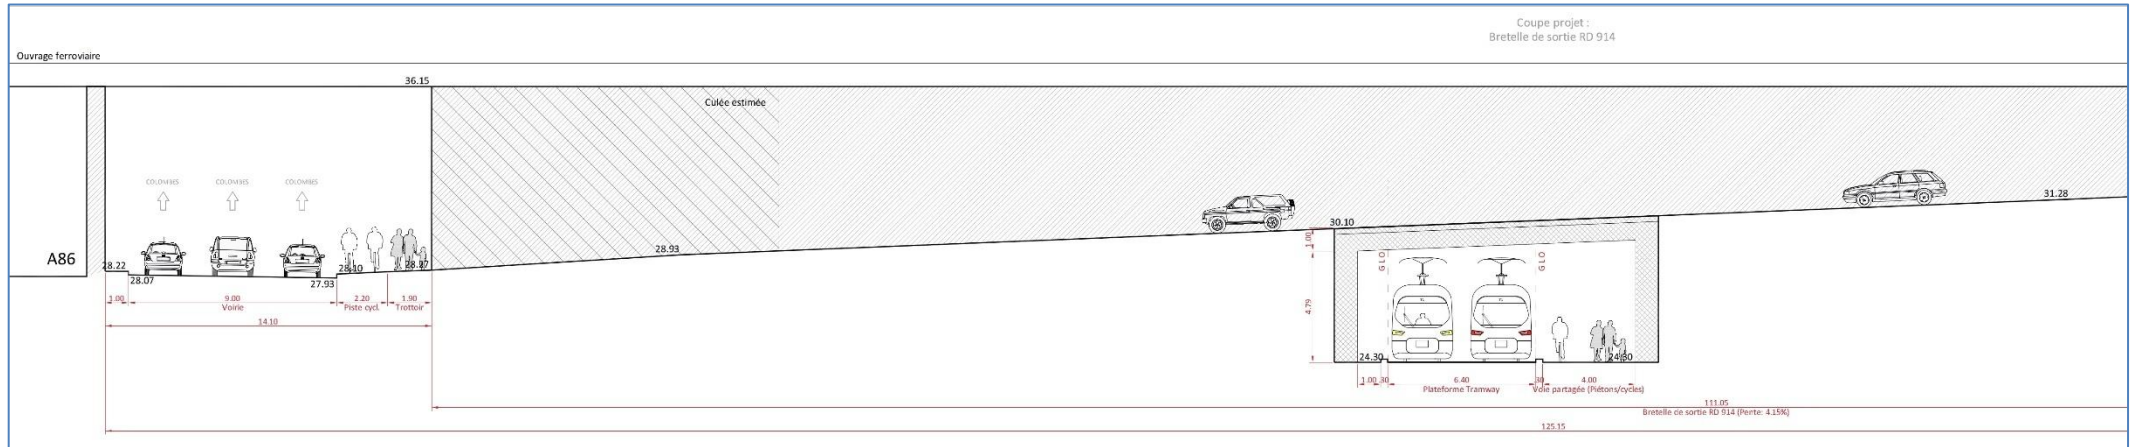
Séquence 1 – section D – Franchissement sans croisement – bretelle de sortie
